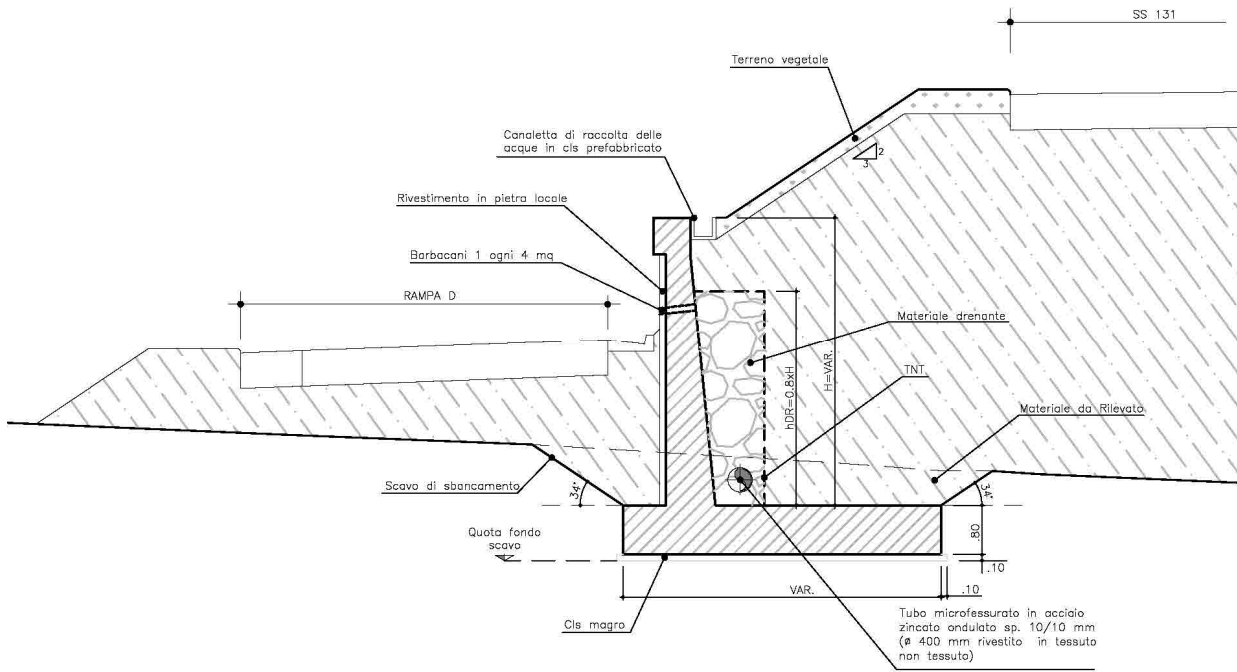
Sezione tipo opera di sostegno con fondazione diretta
